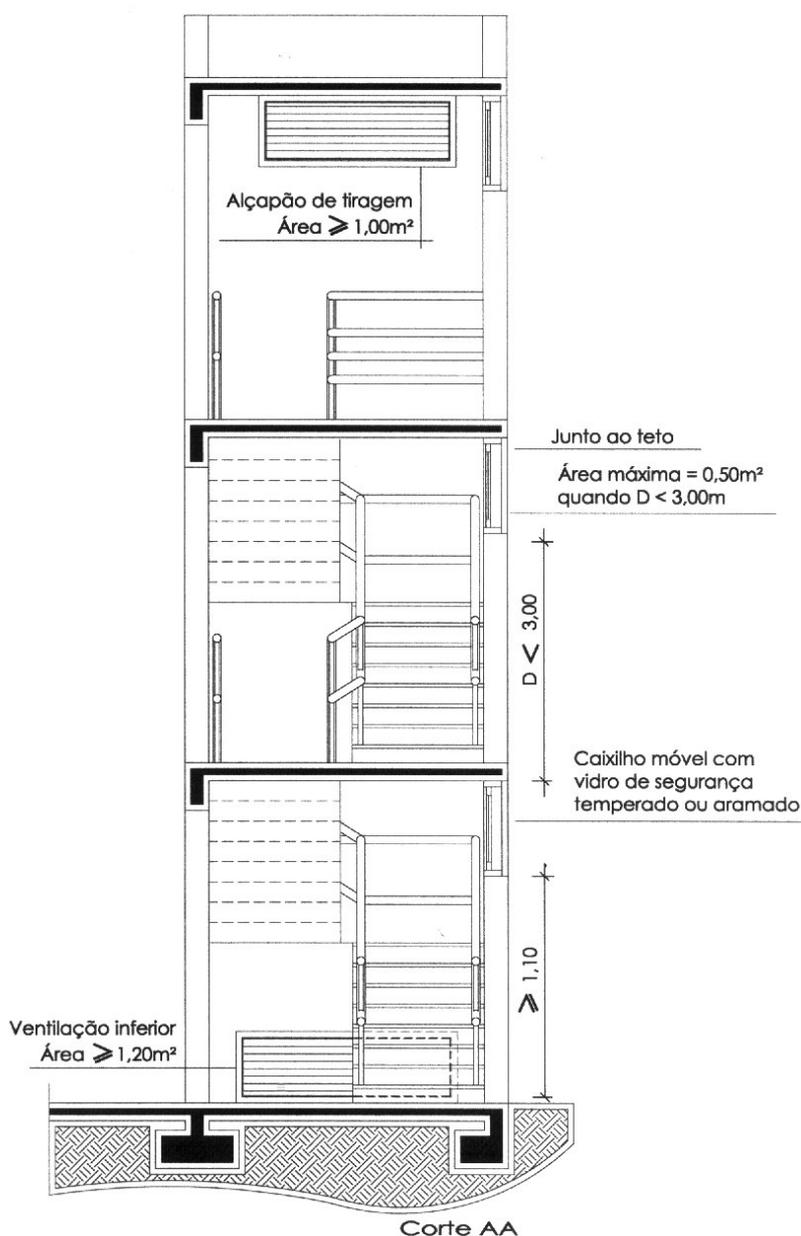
Corte esquemático da escada da Figura 79. Mostra a localização das janelas dentro da caixa protegida, as aberturas de ventilação e a redução da área das aberturas, conforme distância entre elas.
